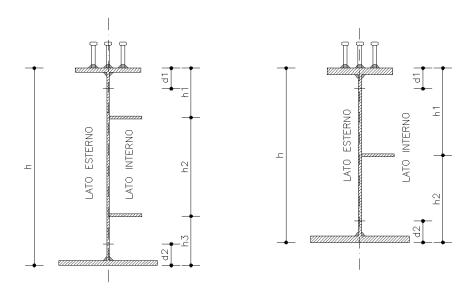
Sezioni travi con individuazione dei sub-pannelli
